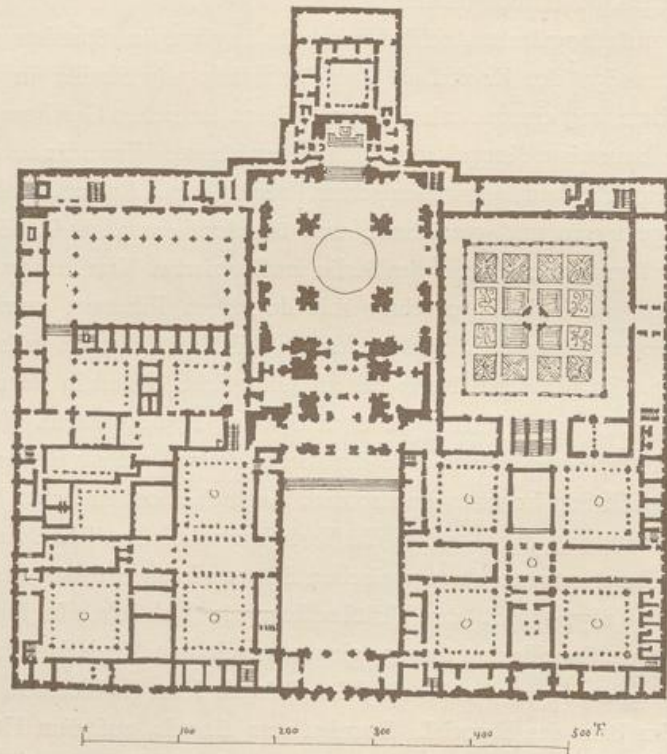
Escorial. Grundplan. (n. Ximenes.)
